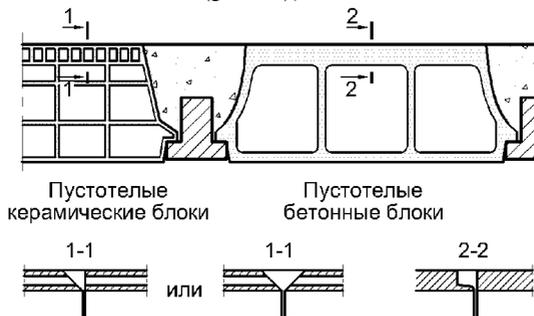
Конструктивное решение плиты перекрытия с «прерывистой» набетонкой
